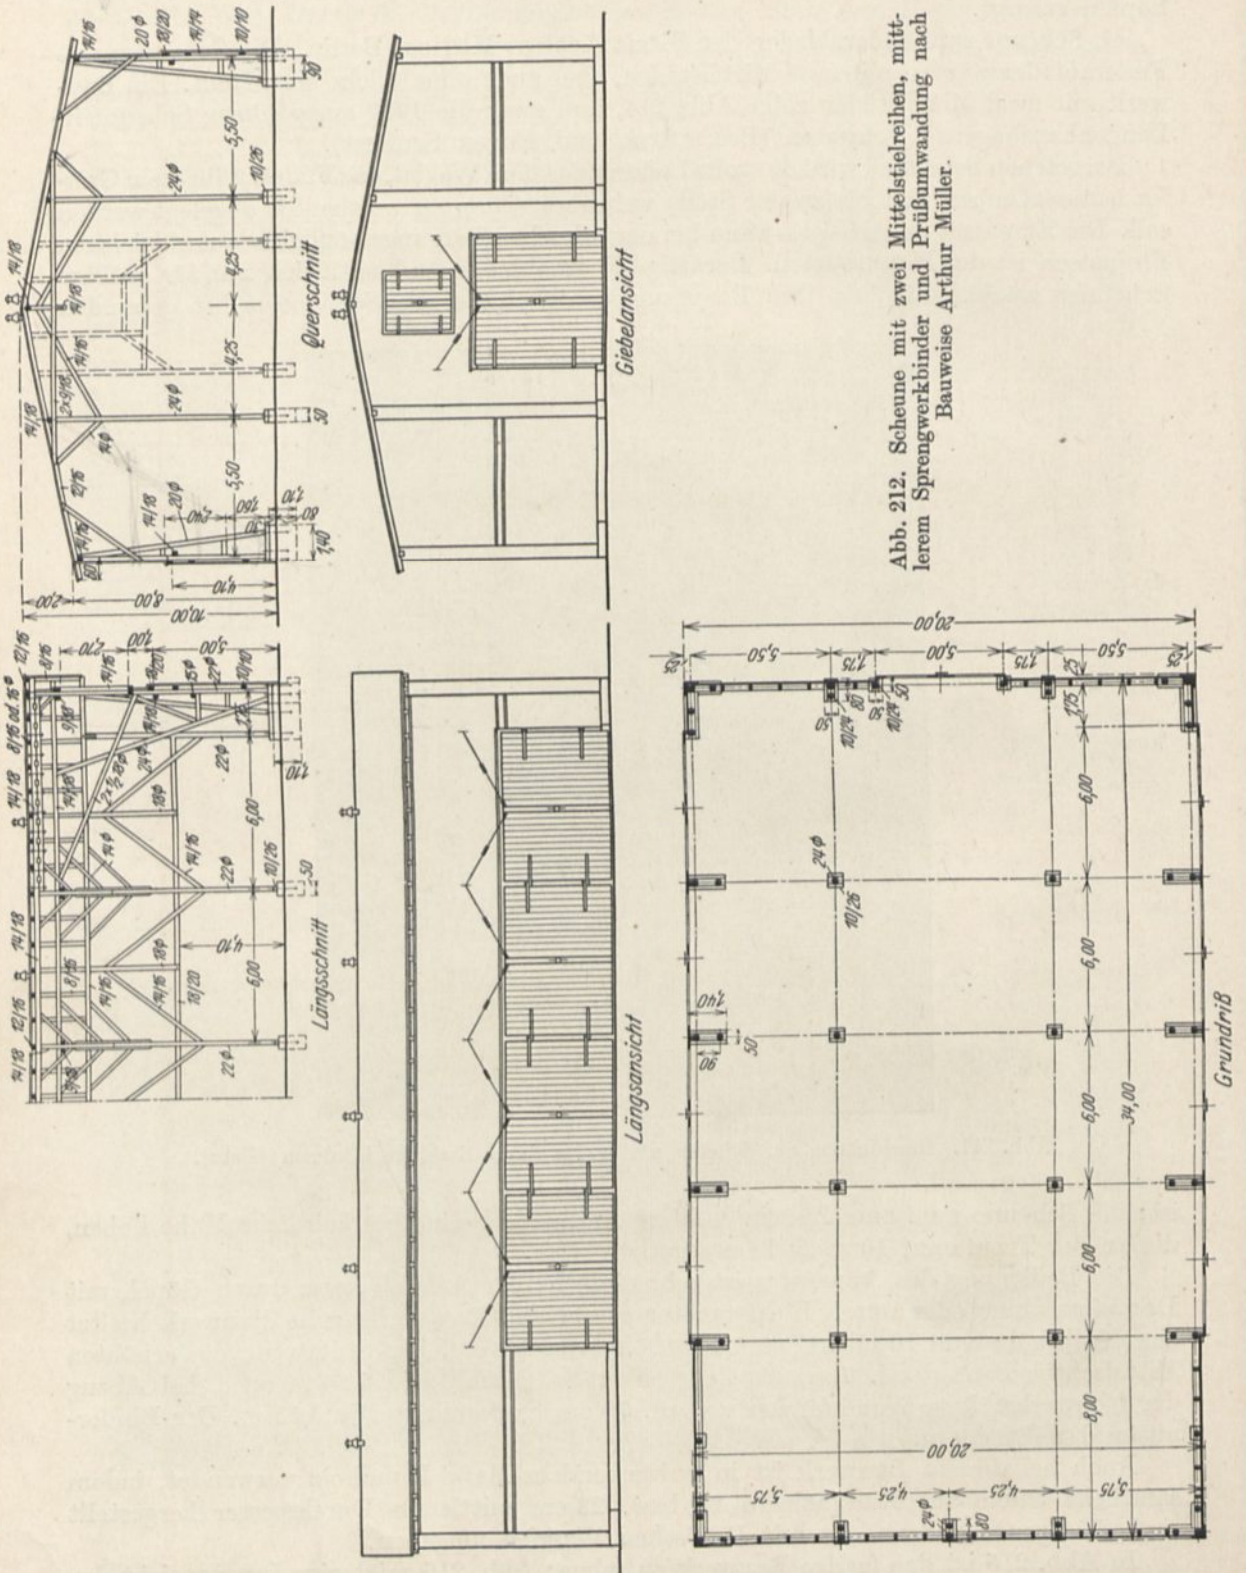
Scheune mit zwei Mittelstieleihen, mittlerem Sprengwerkbinder und Prüfbaumwandung nach Bauweise Arthur Müller.
